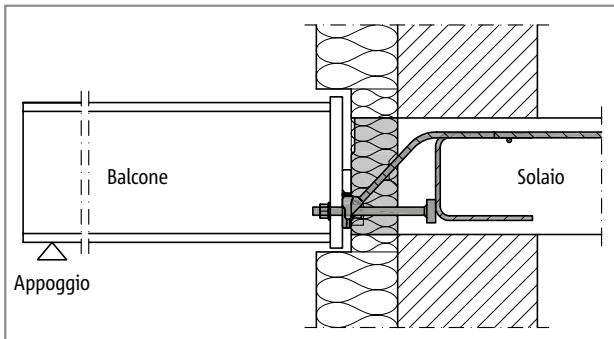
Schöck Isokorb® T tipo SQP: raccordo alla soletta in calcestruzzo armato; materiale isolante nell'isolamento esterno
